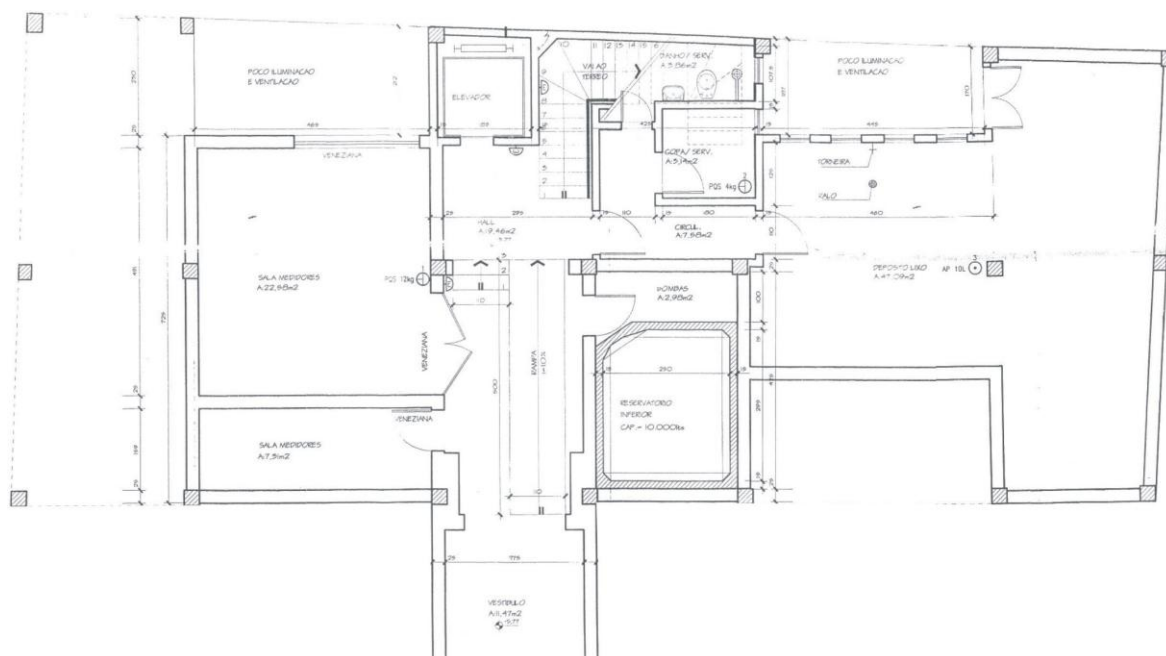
Plano de la Planta baja del Edificio “Utopia e Luta”.
